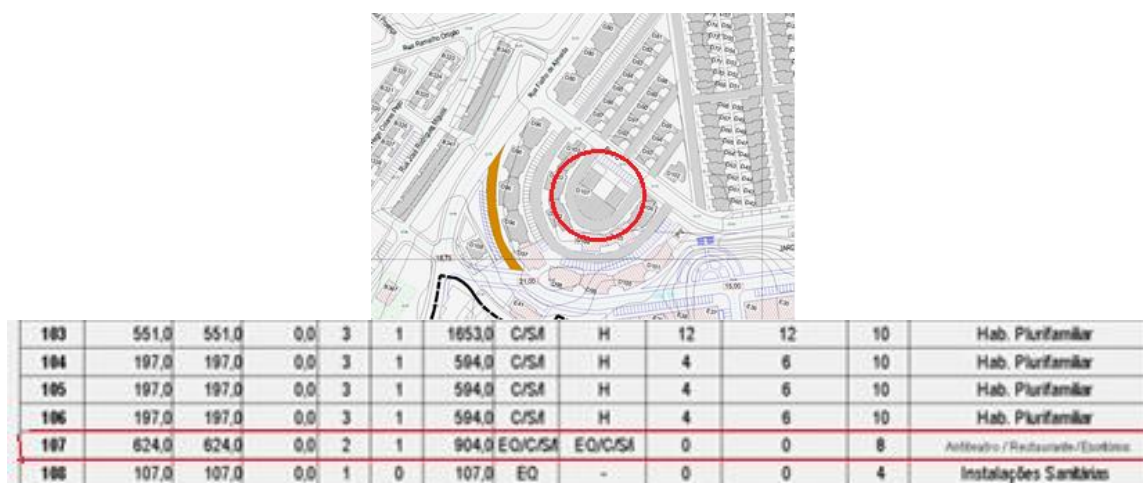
Extrato da Planta de Implantação e respetiva legenda.
